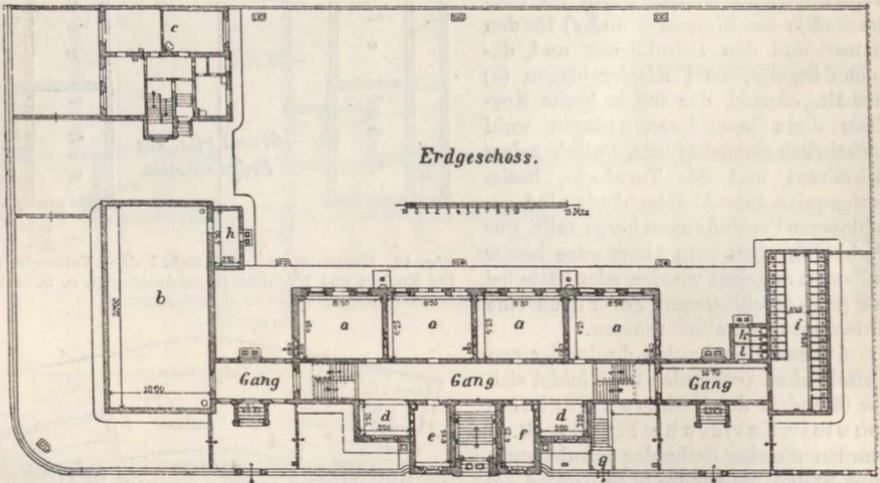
Grundriß vom Erdgeschoß einer gehobenen (Doppel-) Schule für Mädchen in Frankfurt a. M. a Klassenzimmer, b Turnhalle, c Direktorwohnung, d Kleiderablagen, e Heizer, f Schuldienere, h Klosett für Lehrer.
